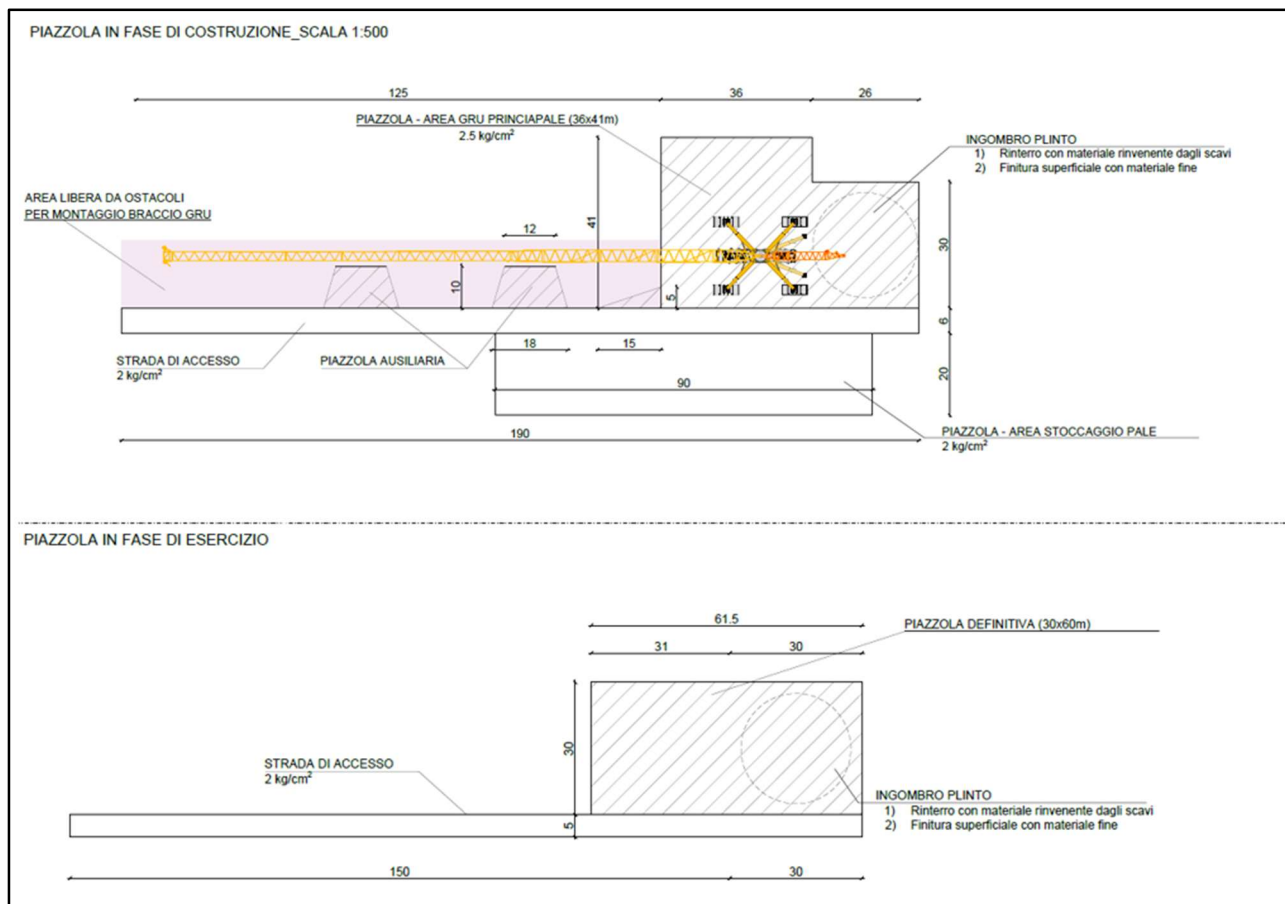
Planimetria piazzola tipo per la fase di installazione e fase di esercizio e manutenzione
